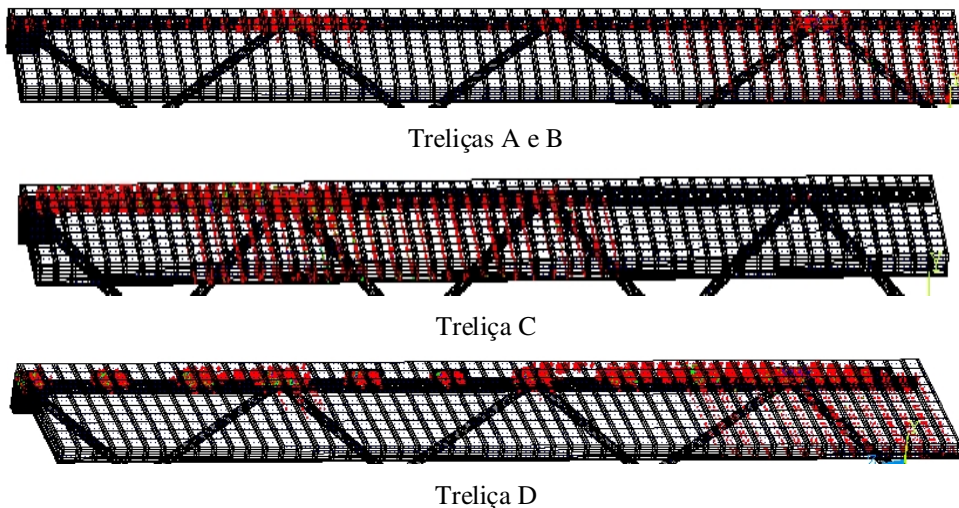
Padrão de fissuração na laje para os carregamentos últimos
